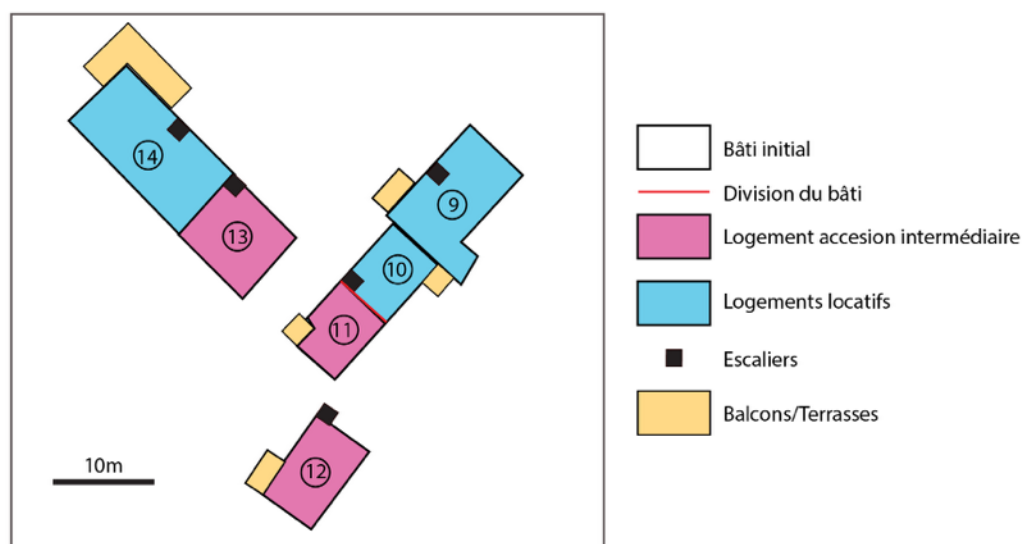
Plan masse R+1 (Réalisation Louis Chaintron)
